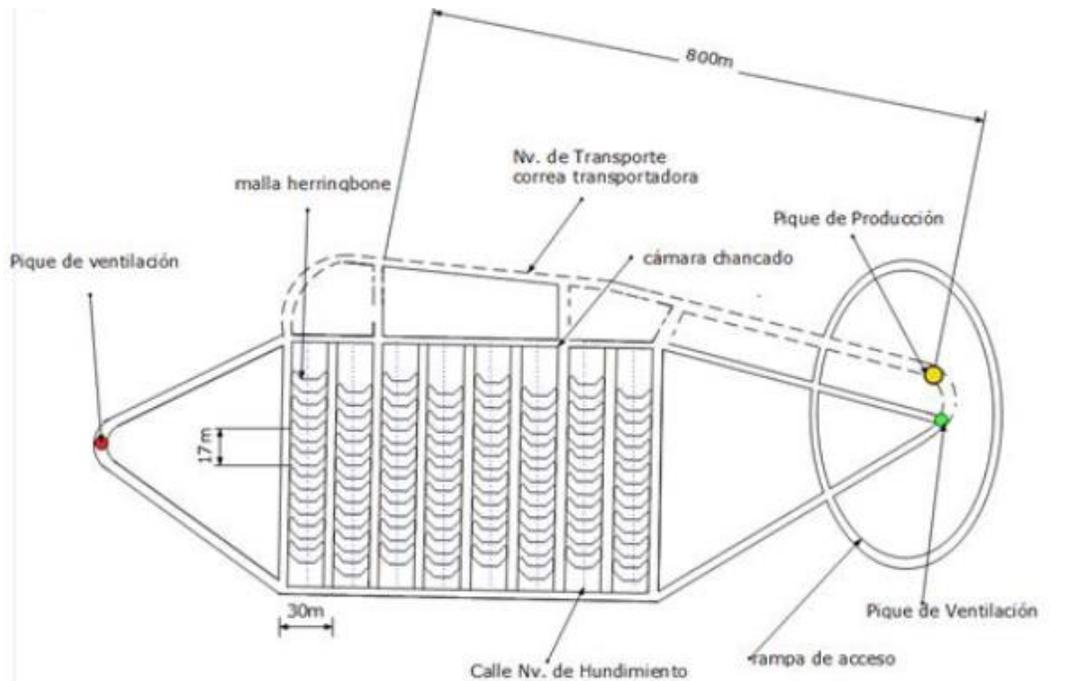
Esquema de una mina de Block Caving, vista en planta.
